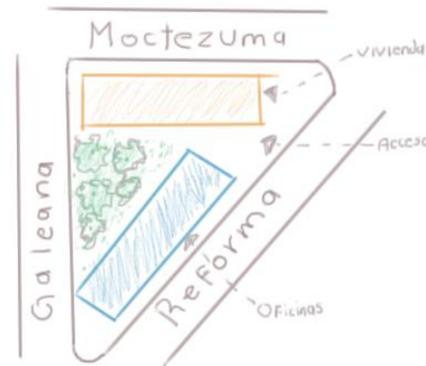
primeras intenciones de emplazamiento y volumetría de proyecto.
